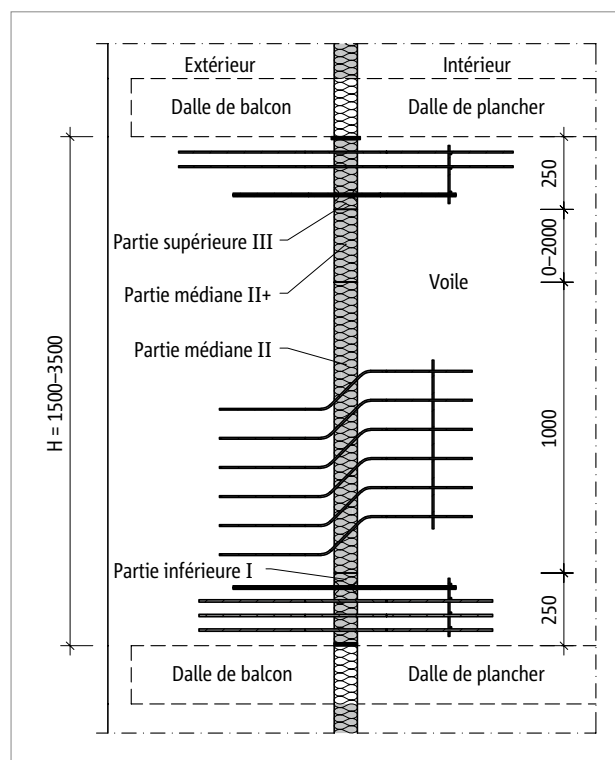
Schöck Isokorb® T Type W : Construction de balcon avec murs de refend porteurs isolés thermiquement
